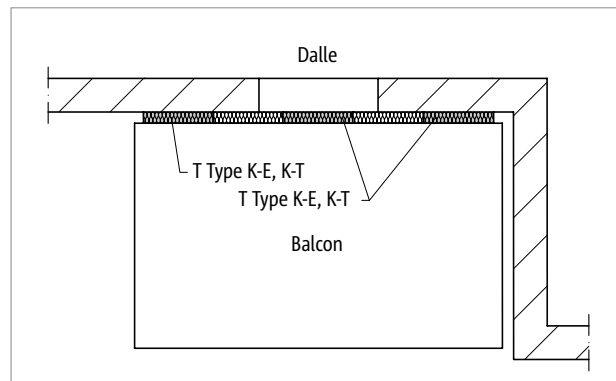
Schöck Isokorb® T Type K-E, K-T : Balcon avec décrochement de façade
